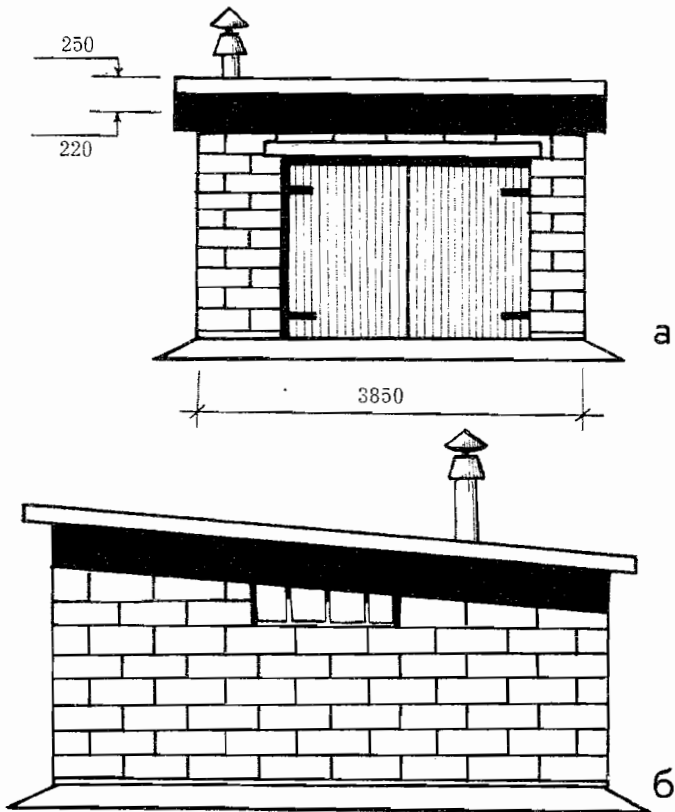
Кирпичный гараж: а — общий вид; б — вид сбоку.
